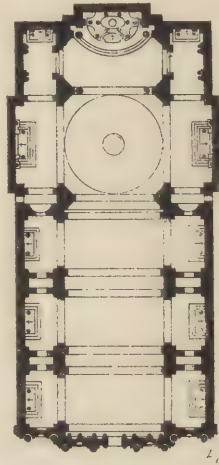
St. Maria dei Gesuiti zu Venedig. Grundriss.
